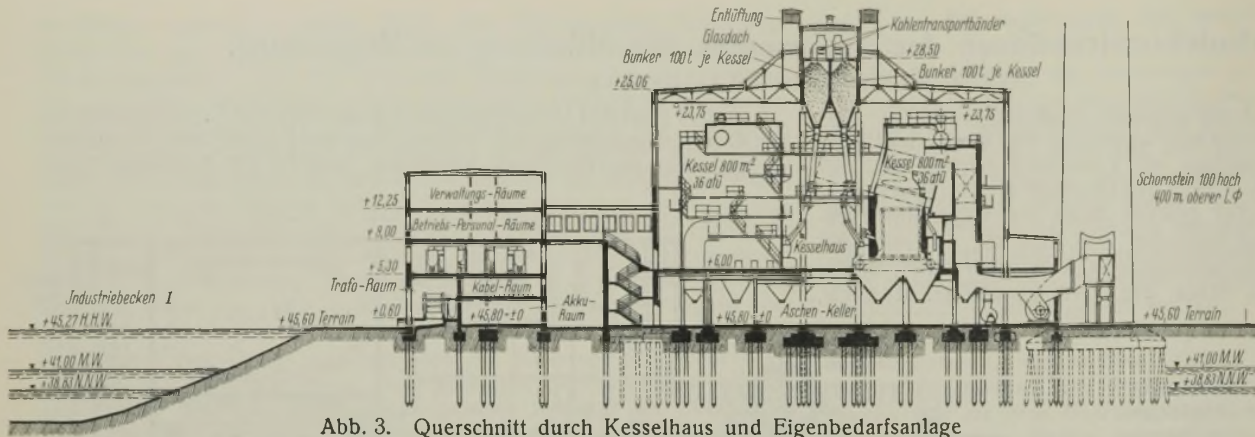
Querschnitt durch Kesselhaus und Eigenbedarfsanlage mit Verwaltungsgebäude.
